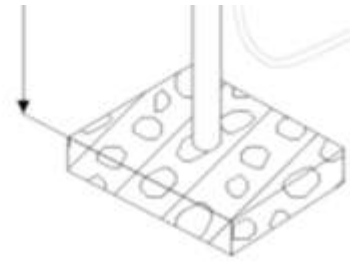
Croquis de la fondation avec dalles de chaussée
